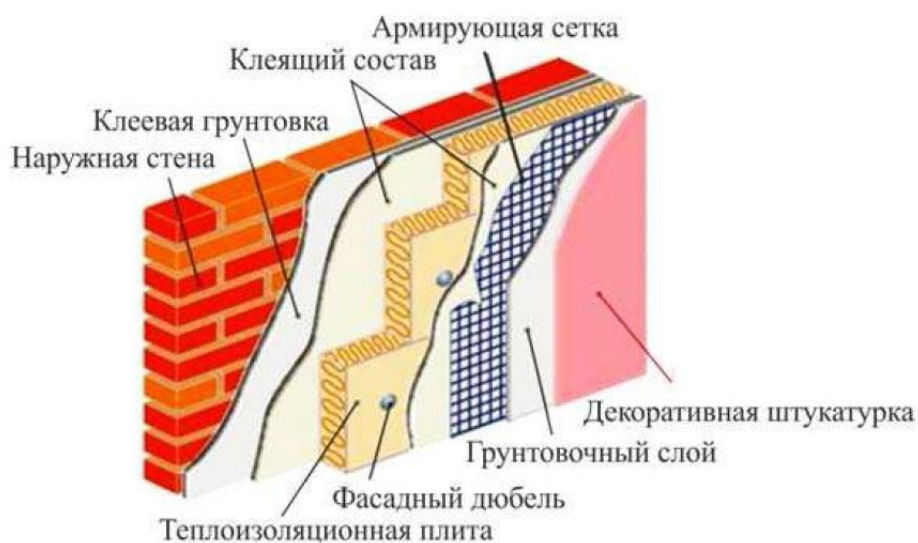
Поэлементная схема утепления по типу «мокрый» фасад
